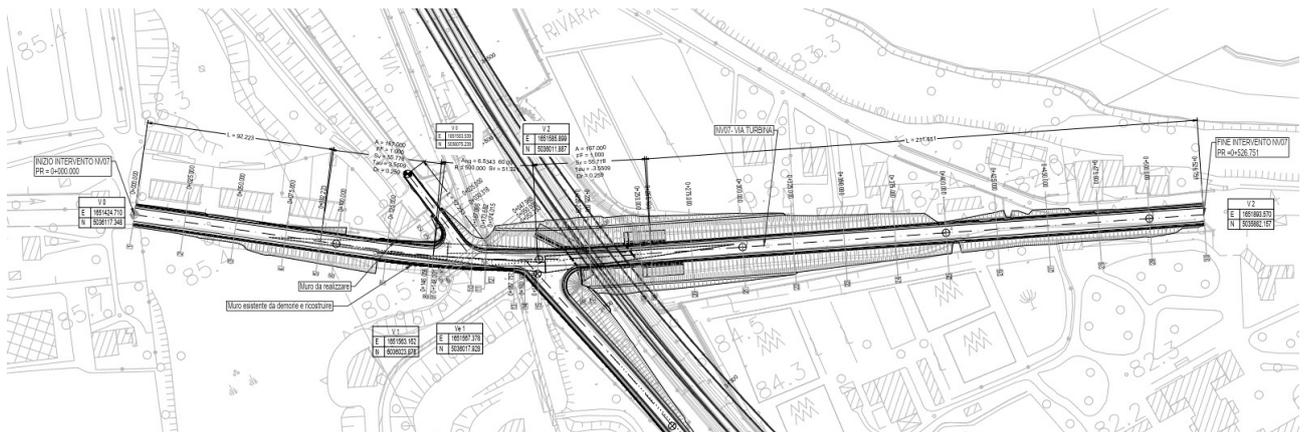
NV07 – Stralcio planimetrico su rilievo di via Turbina e via Bionde
